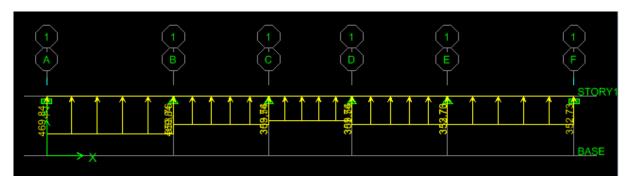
Schéma statique de la nervure ELU (sens longitudinal).
